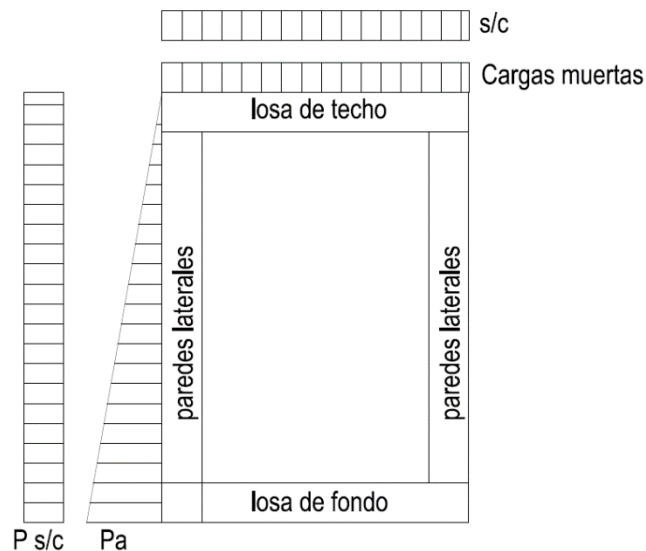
Diagrama de distribución de cargas en el muro cisterna
